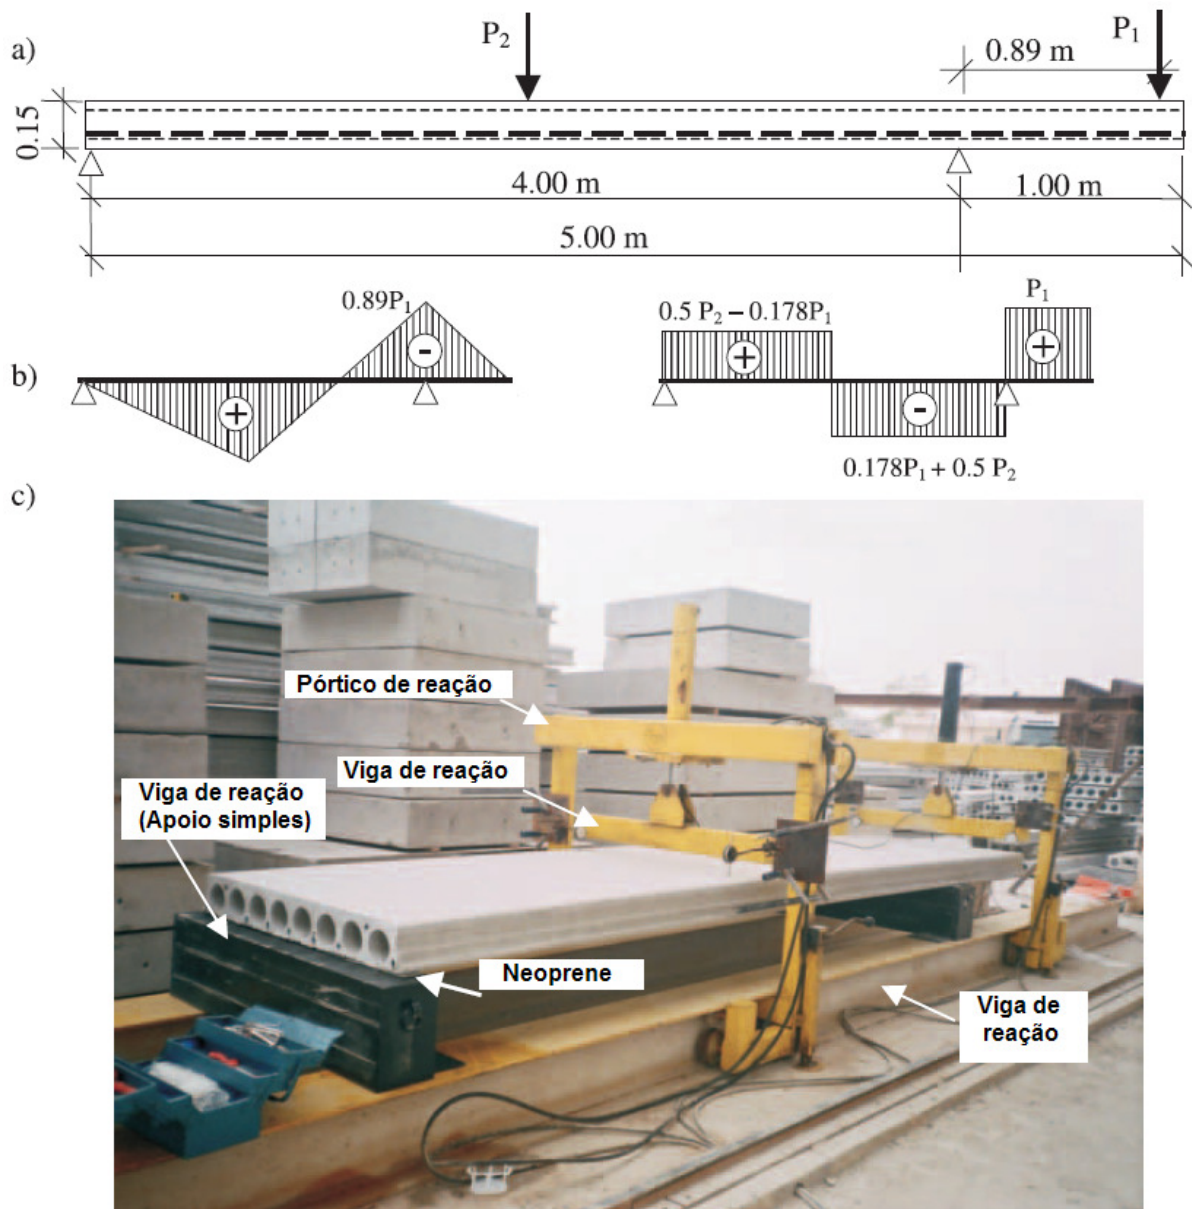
Ensaio de ligação laje-viga realizado por MARCELLINO (2011).
